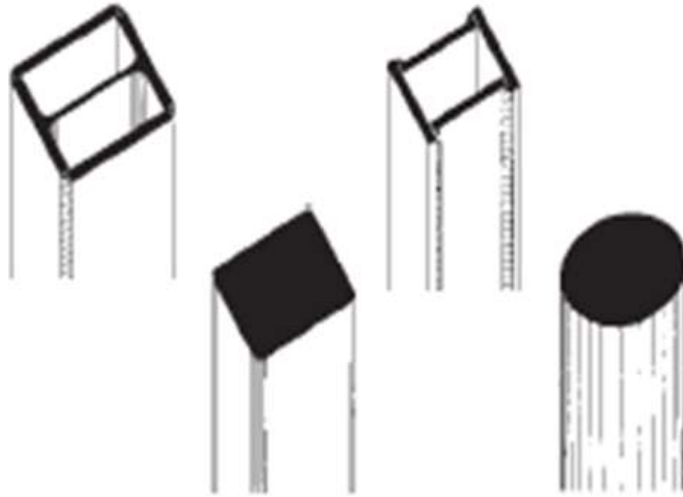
SECTIONS EN CAISSON RECTANGULAIRES ET SECTIONS PLEINES EN ACIER
